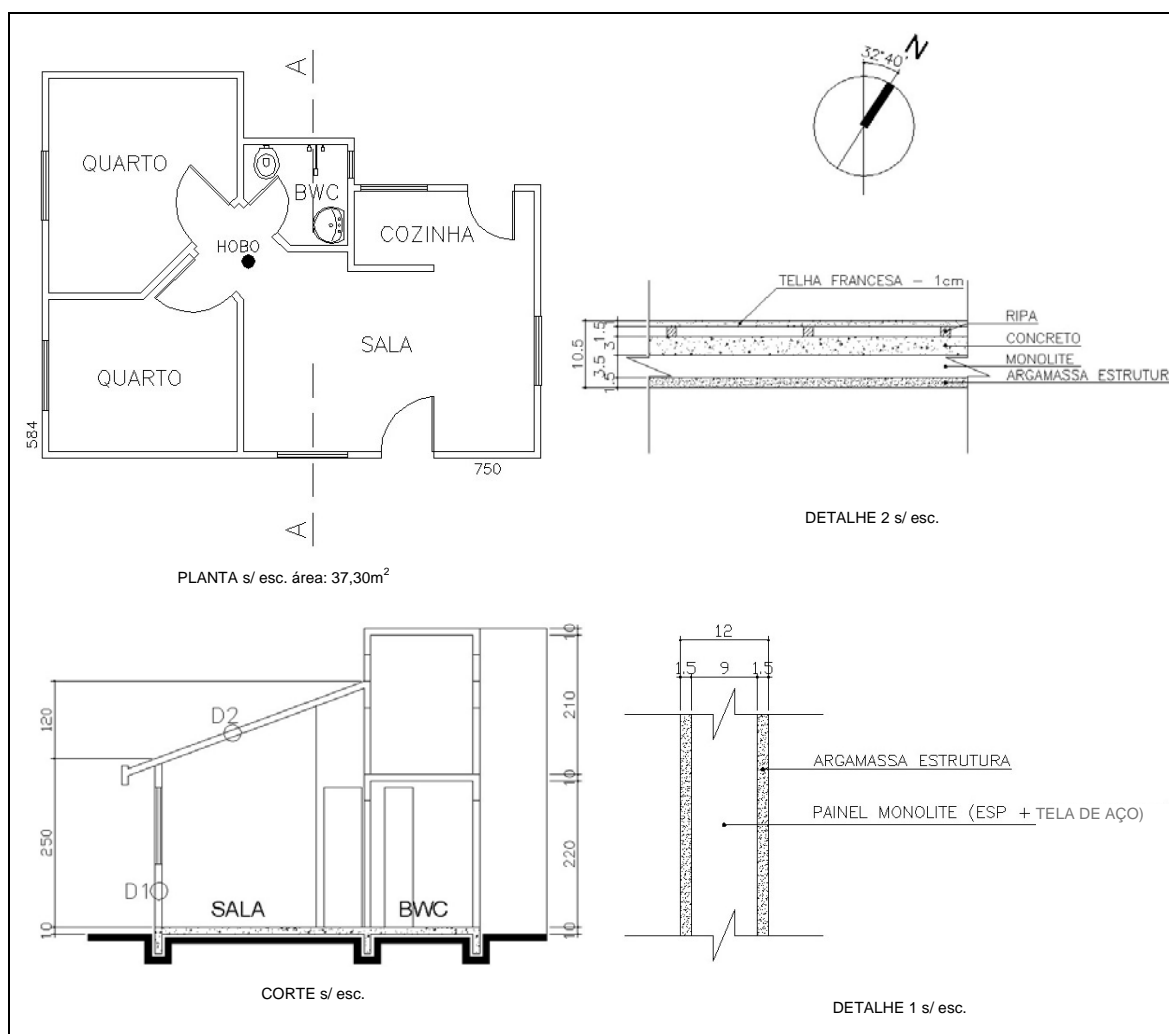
Planta, corte e detalhes do sistema construtivo Constroyer (DUMKE, 2002)
